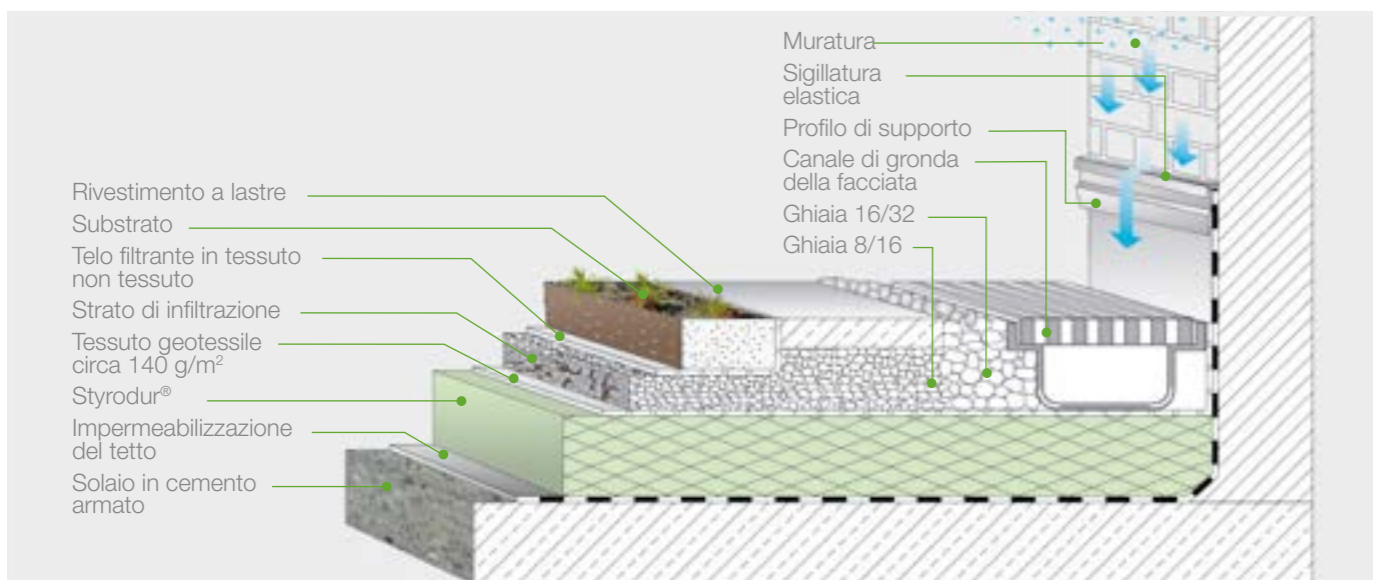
Collegamento di tetto verde rovescio a una parete verticale con canale di gronda sulla facciata.
